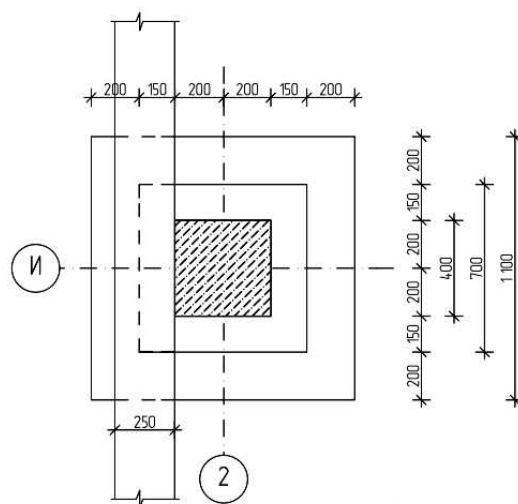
Схема столбчатого фундамента Ф-2, вид сверху.
